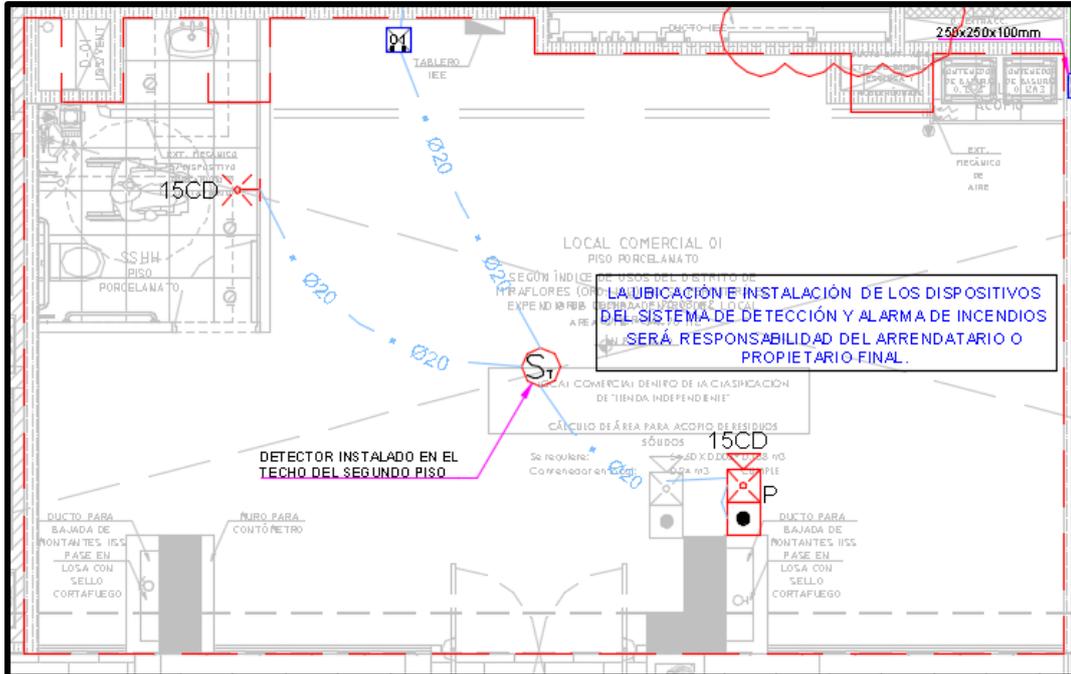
Ubicación de Equipos en plano del local comercial en el primer piso.
